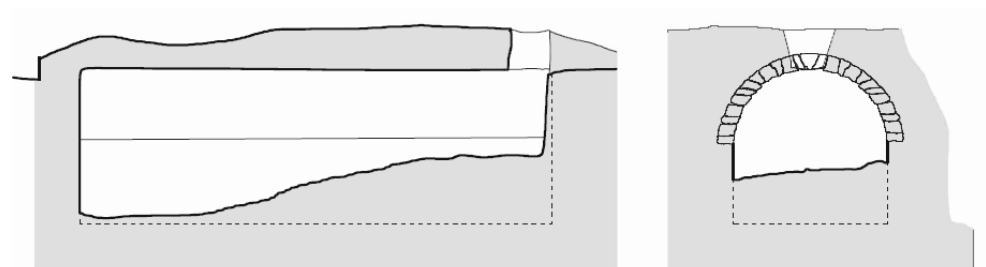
Muralla de tapia, cañonera y cimentación.
